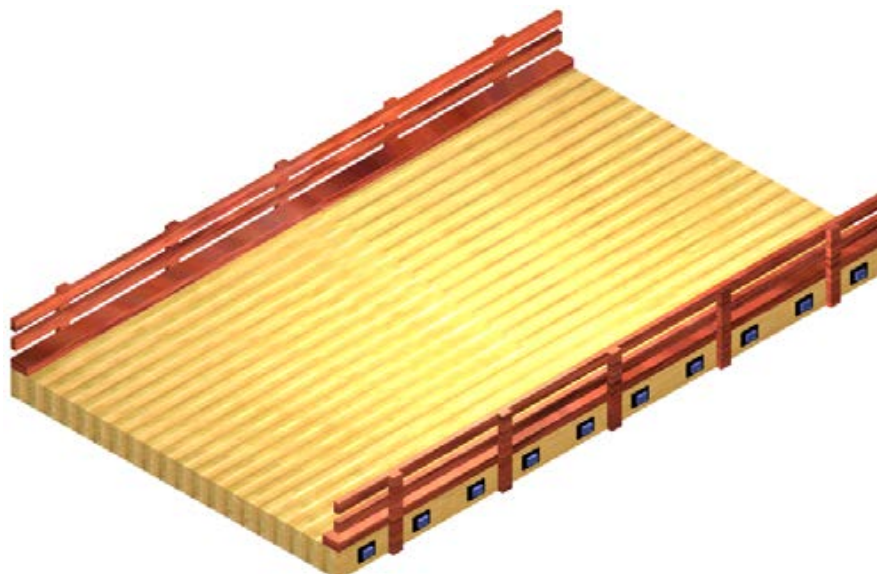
Ponte de tabuleiro laminado protendido transversalmente. Fonte: OKIMOTO (2002)
